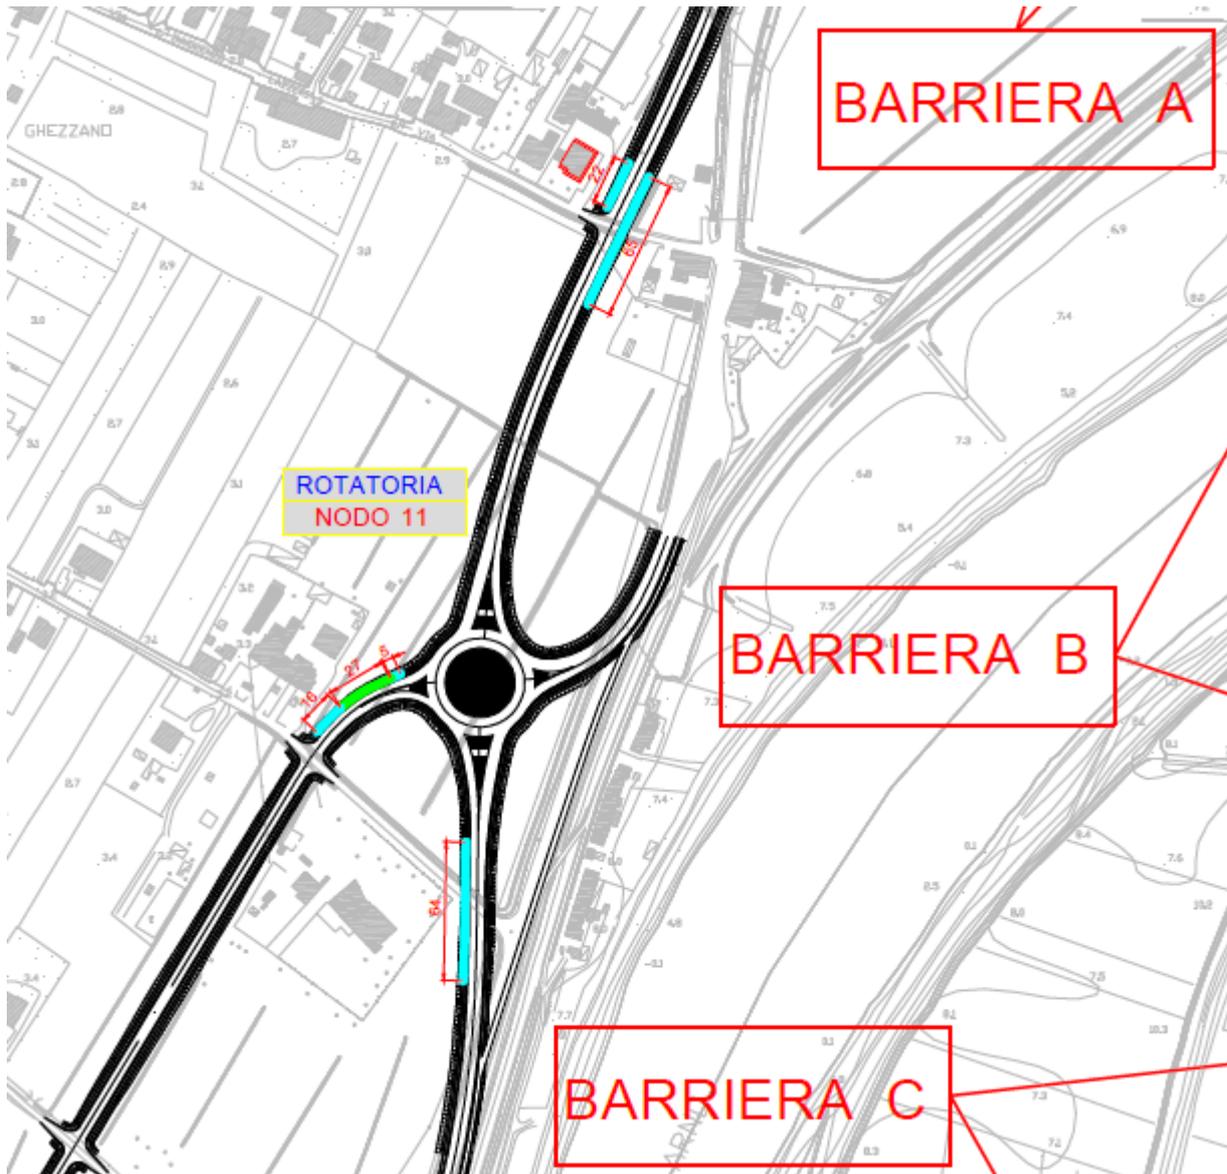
Planimetria barriere acustiche tratto 10-11 (lotto 10-12)
